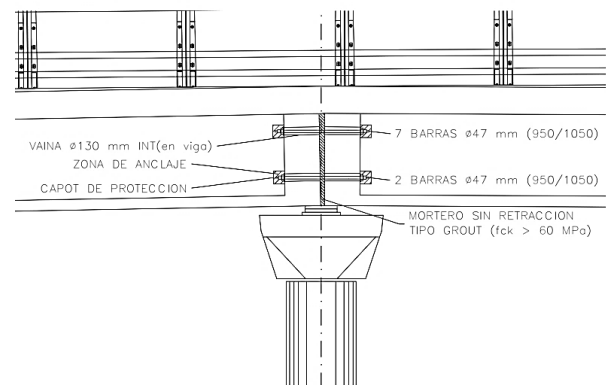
Barras pretensadas de conexión entre vigas de diferentes vanos
